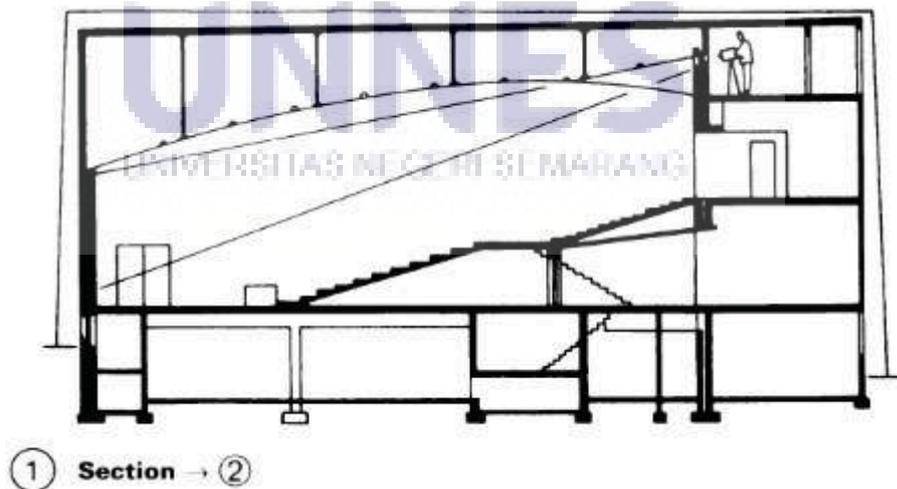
Bentuk Denah Ruang Pertunjukan Seni Ludruk
